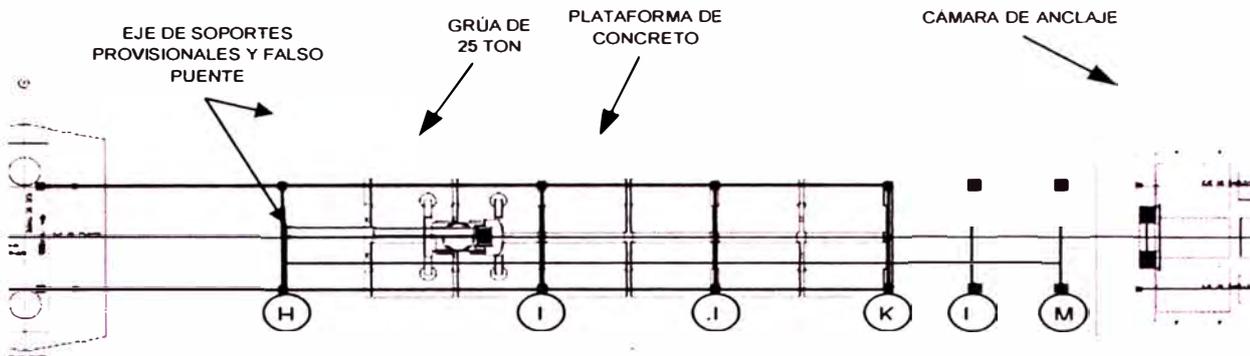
VISTA PLANTA DEL MONTAJE DEL SOPORTE PROVISIONAL
